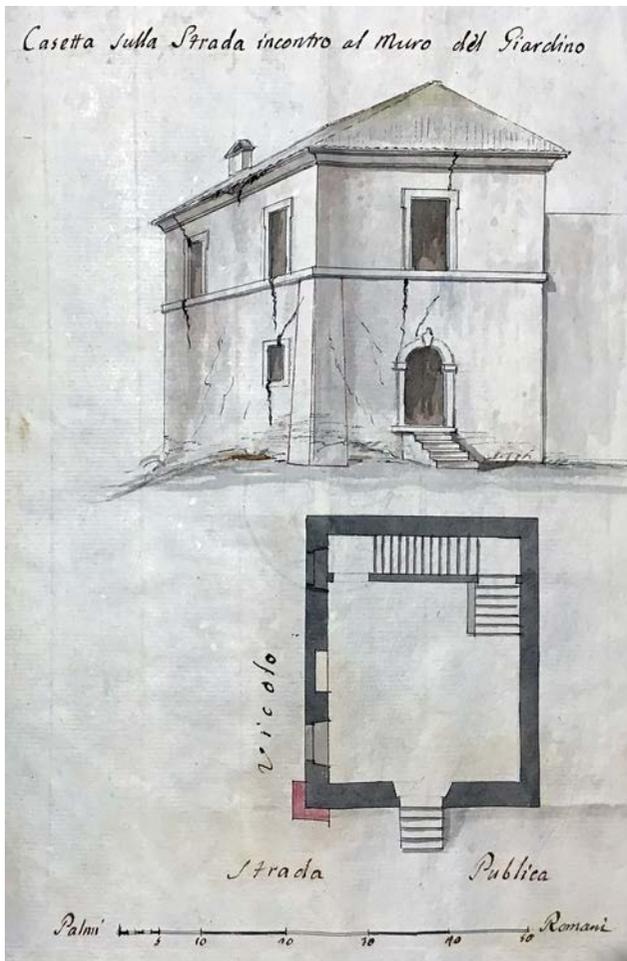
Benedetto Piernicoli, “Casetta sulla strada incontro al muro del Giardino” (1808). ASR, fondo Albani, b. 60, fasc. Perizie, e Relazioni del Sig.r Piernicoli [...], cc. n. n., ad diem, (su concessione del MiBACT, divieto di ulteriore riproduzione).
